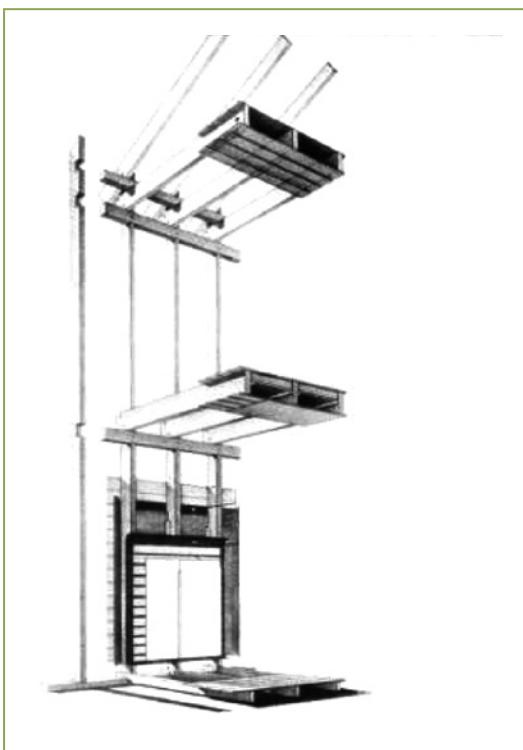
Bohlenbauweise mit Unterrähm und seitlich befestigten Deckenbalken (Quelle: [18])
